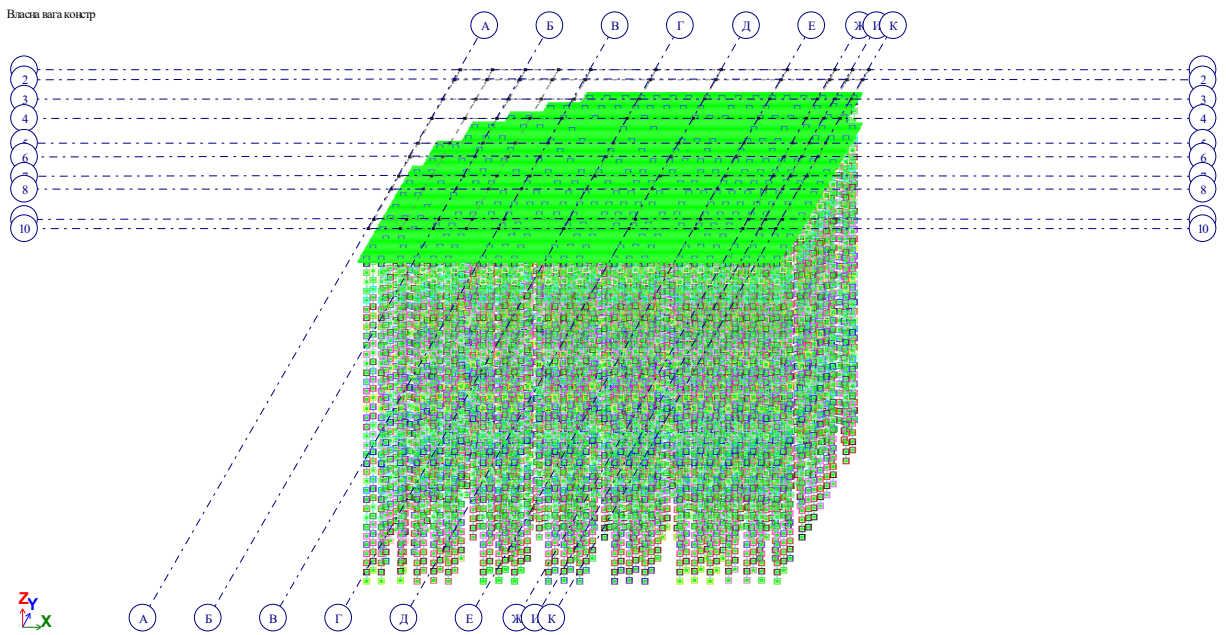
Розрахункова модель плитно-пального фундаменту
